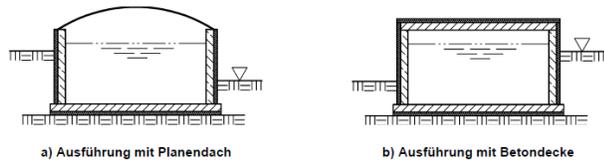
Gedeckte außen gedämmte Biogasbehälter
